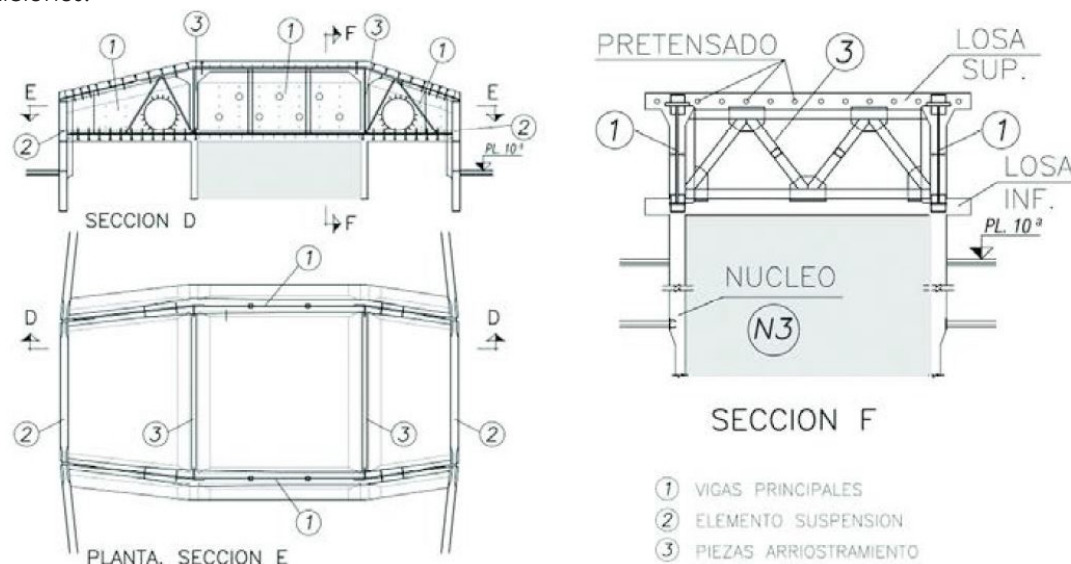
Viga cajón de suspensión. Detalle constructivo.
